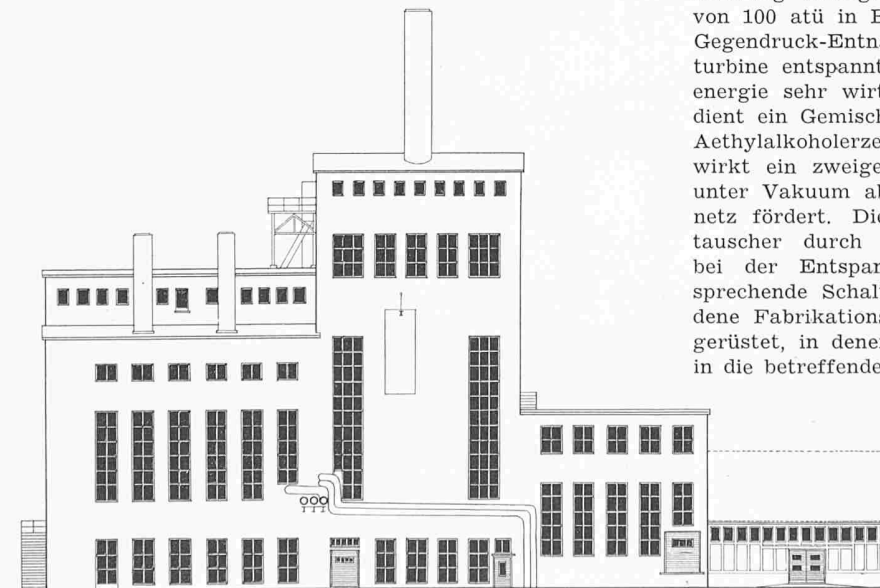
Aussenansicht des Kesselhauses, Masstab 1:500
